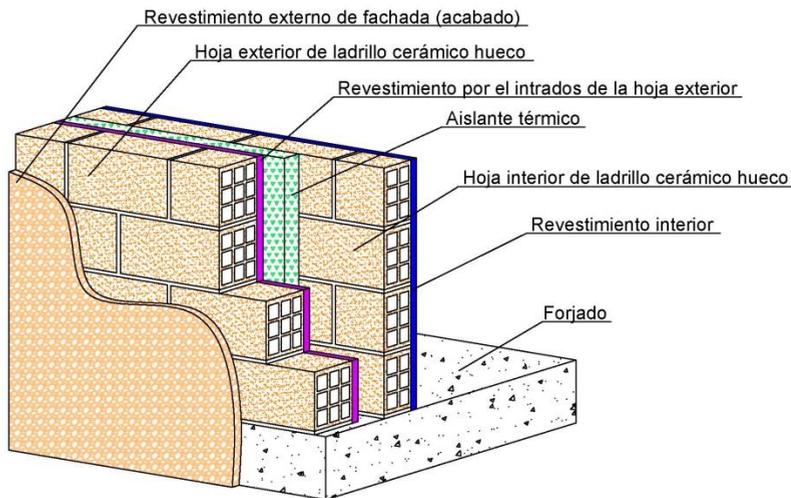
Detalle de fachada caravista de dos hojas. Fuente Eva Vidal
